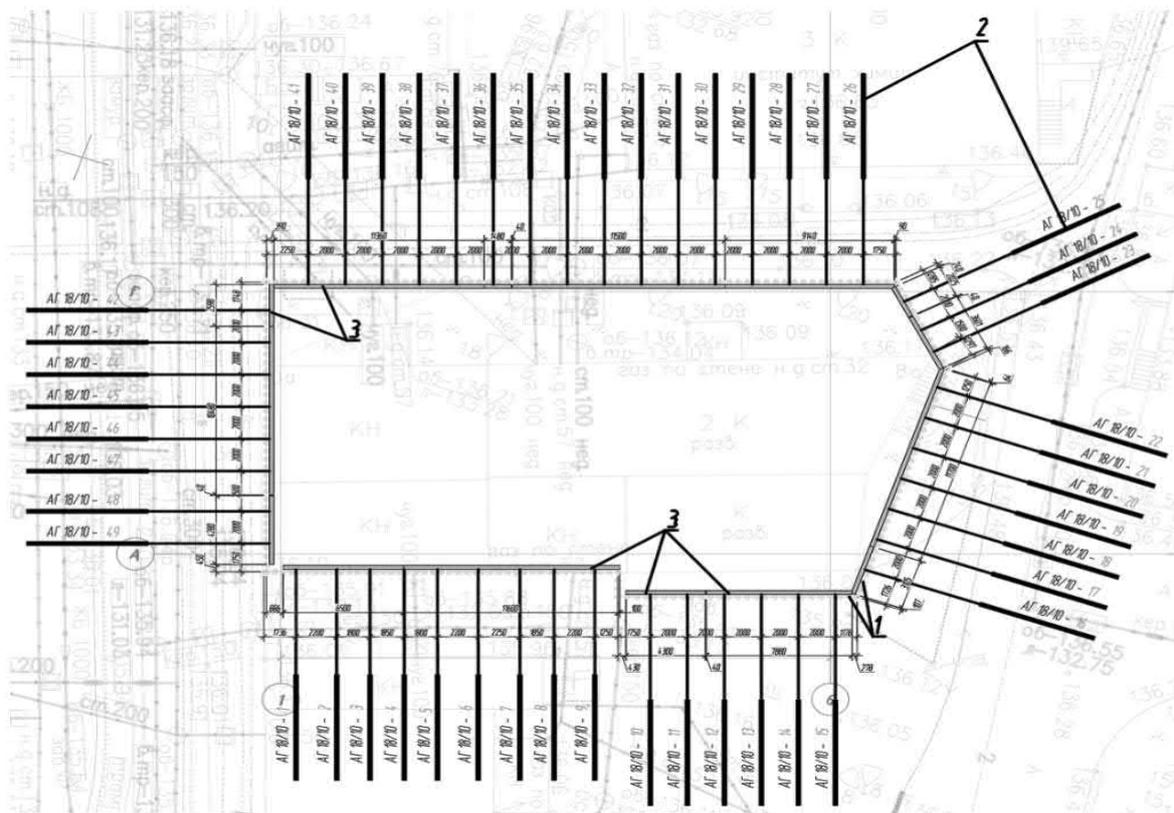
Схема размещения грунтовых анкеров ЭРТ ограждения котлована:
